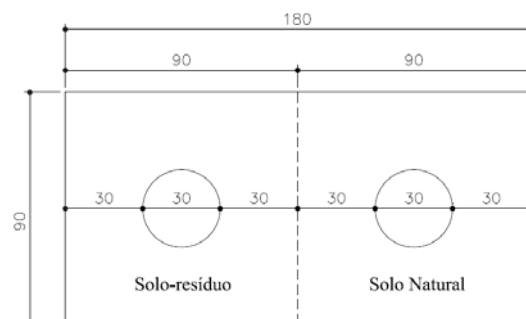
Posicionamento das placas e dimensões – vista superior (dimensões em cm)
